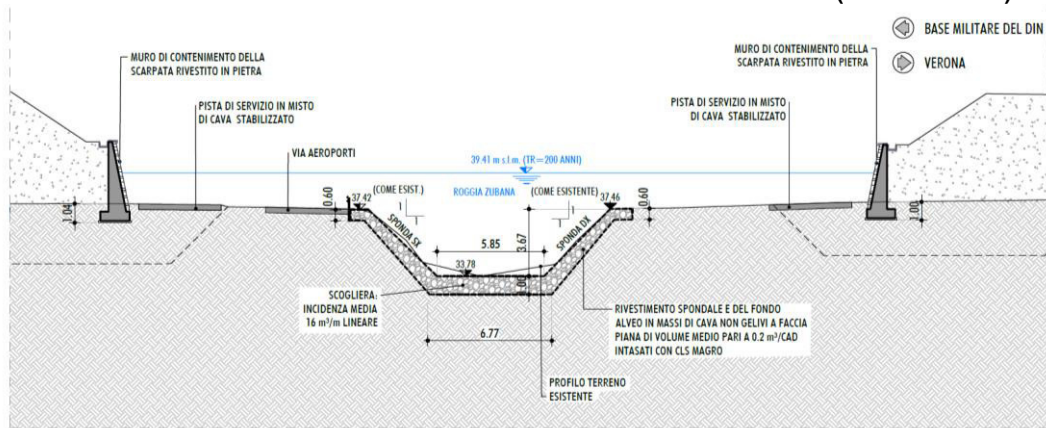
ROGGIA ZUBANA: SEZIONE B-B FUORI DALL'OMBRA DEL PONTE (VISTA DA MONTE)
